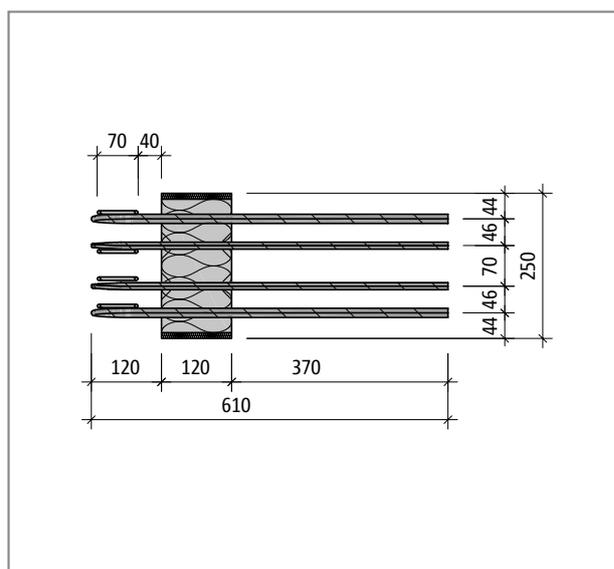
Schöck Isokorb® XT type F: Product plan view
